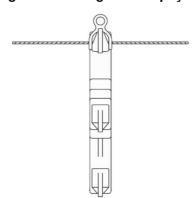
Amarrações e ancoragens – Mensageiro – Espaçadores – Com anel de amarração
